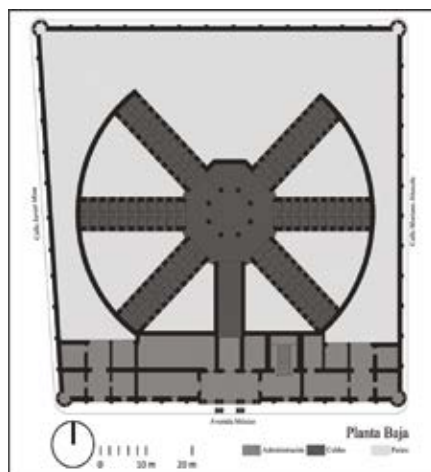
Reconstrucción de la planta arquitectónica baja de la Penitenciaría de Tepic en 1880.
